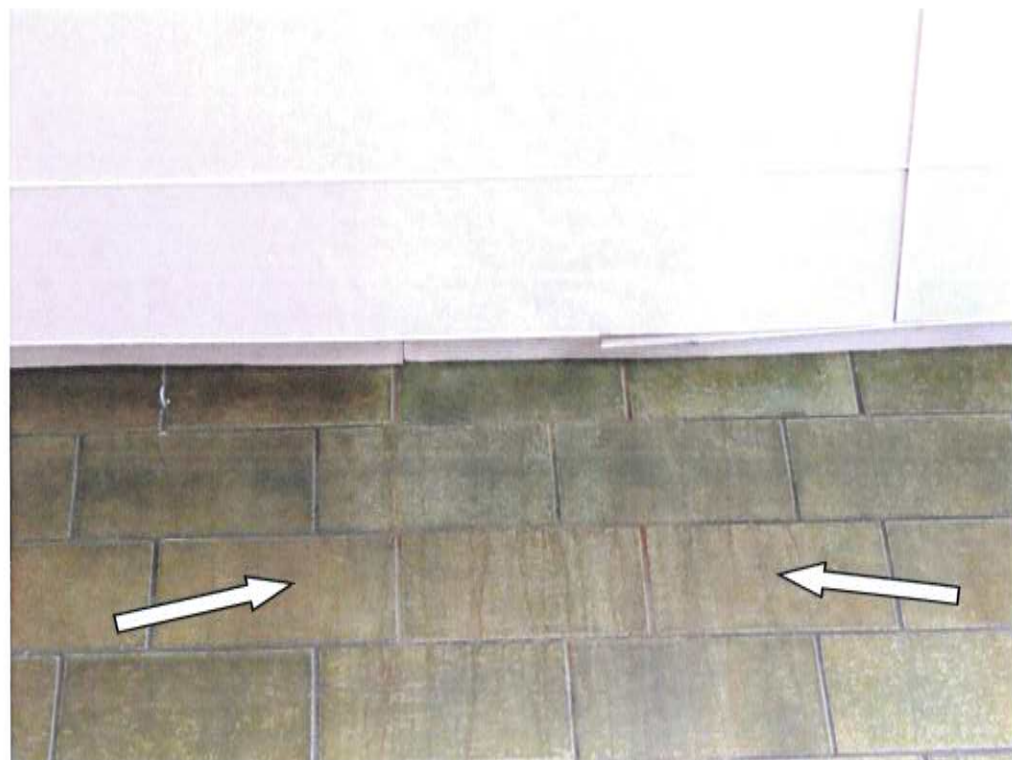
Wände im Dachbereich: Detailaufnahme zu Foto 47 mit Spuren Wasserschaden
